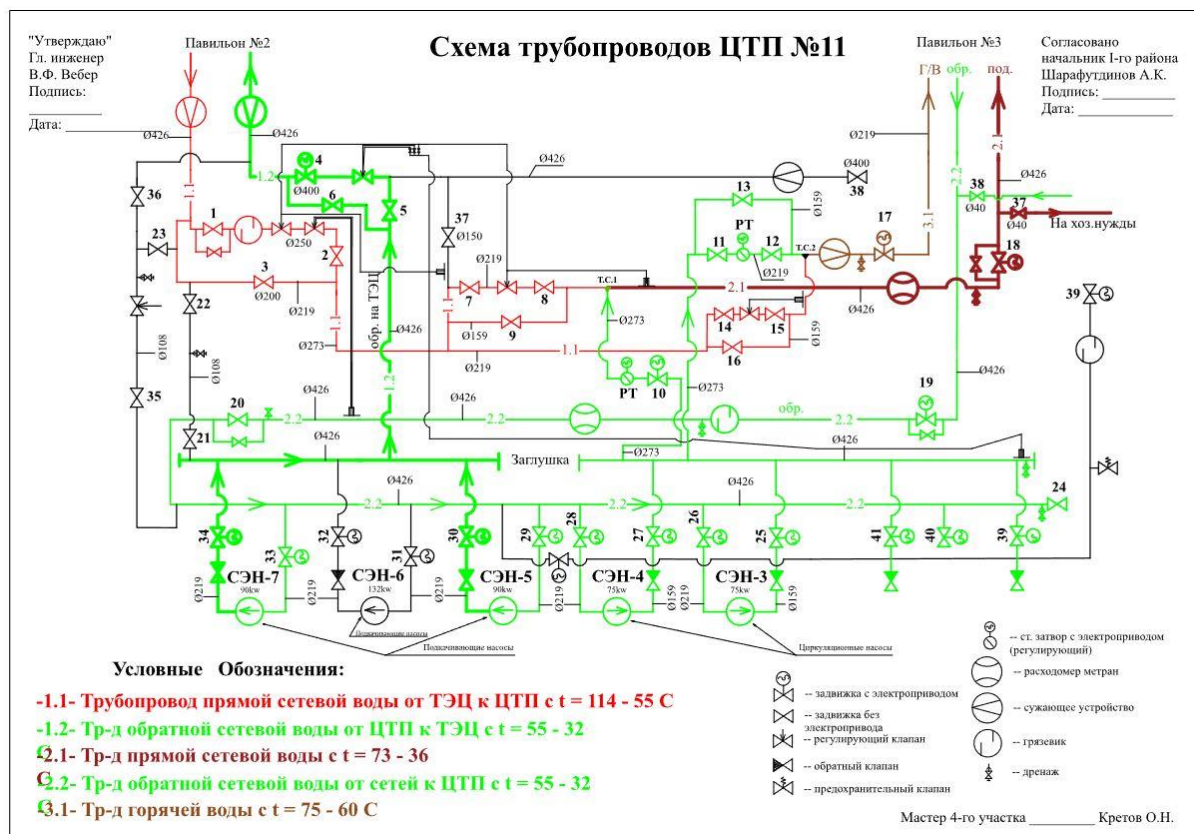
Схема трубопроводов ЦТП №11
